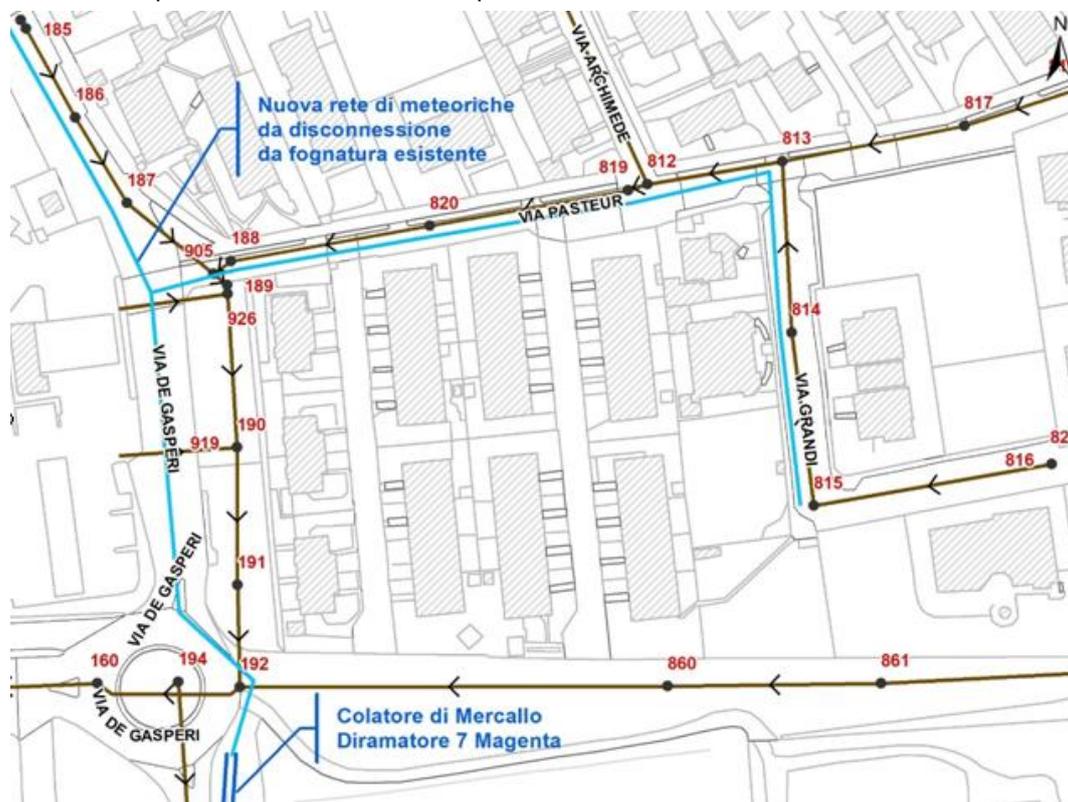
Area di intervento – variante stato di progetto IS07-2
